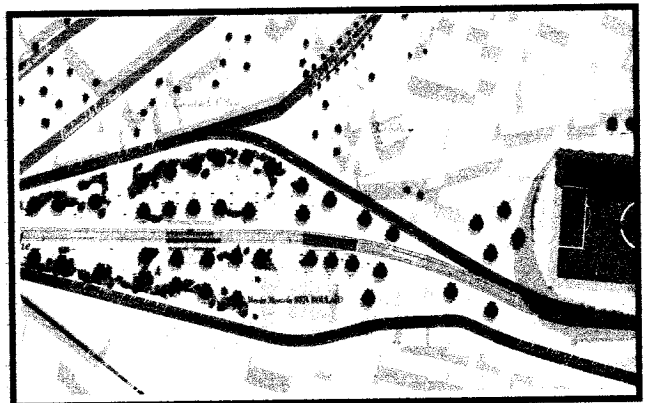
PROPOSITION D'AMENAGEMENT DU STADE BENADELMALEK DANS LE CADRE DU PROJET DE LA LIGNE DU TRAMWAY DE CONSTANTINE
